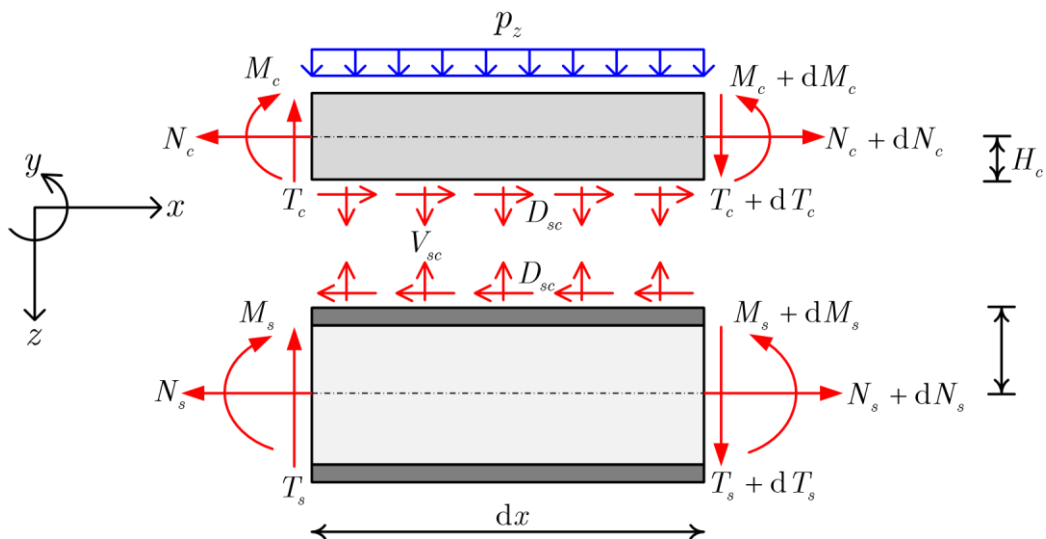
Élément infinitésimal d'une poutre mixte.
